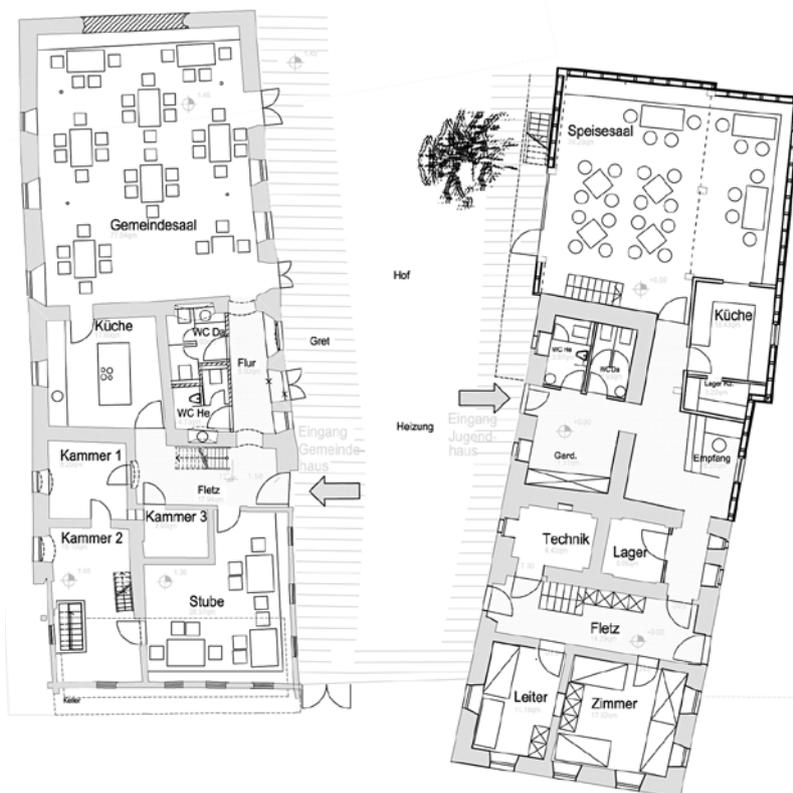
Abtschlag, Gde. Kirchdorf im Wald, Hintberger Str. 6 (Lkr. Regen). Grundriss
